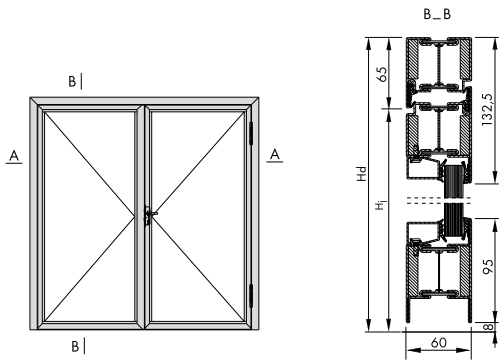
Porte profilée coupe-feu en acier, système Jansen.
